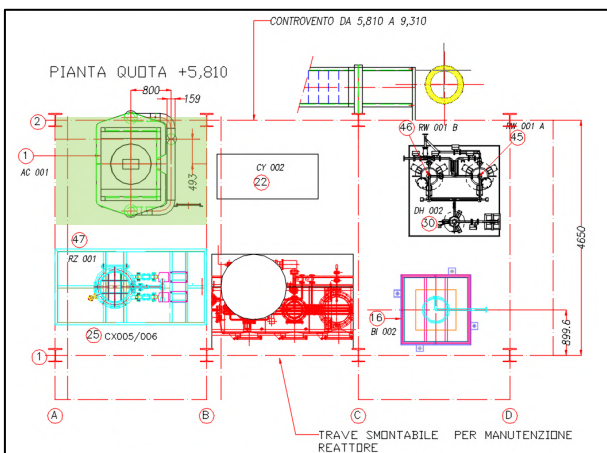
Pianta dell'area dell'impianto a quota 5810.
